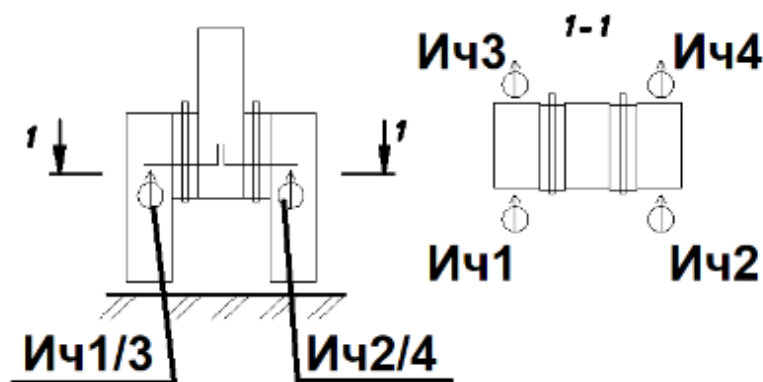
Схема установки индикаторов часового типа для измерения смещений
